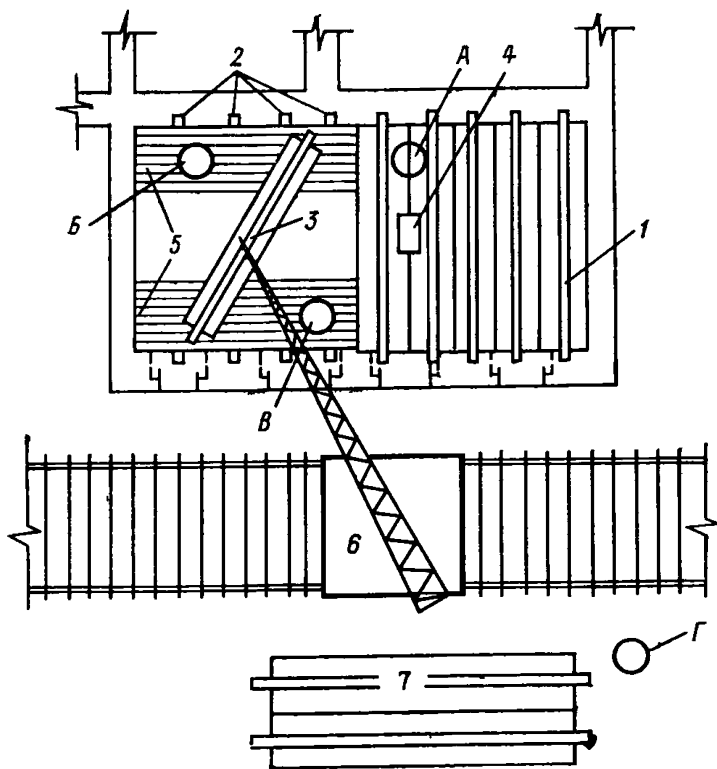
Схема организации работ на захватке по монтажу перекрытий из железобетонных балок-настилов с широкими нижними полками
